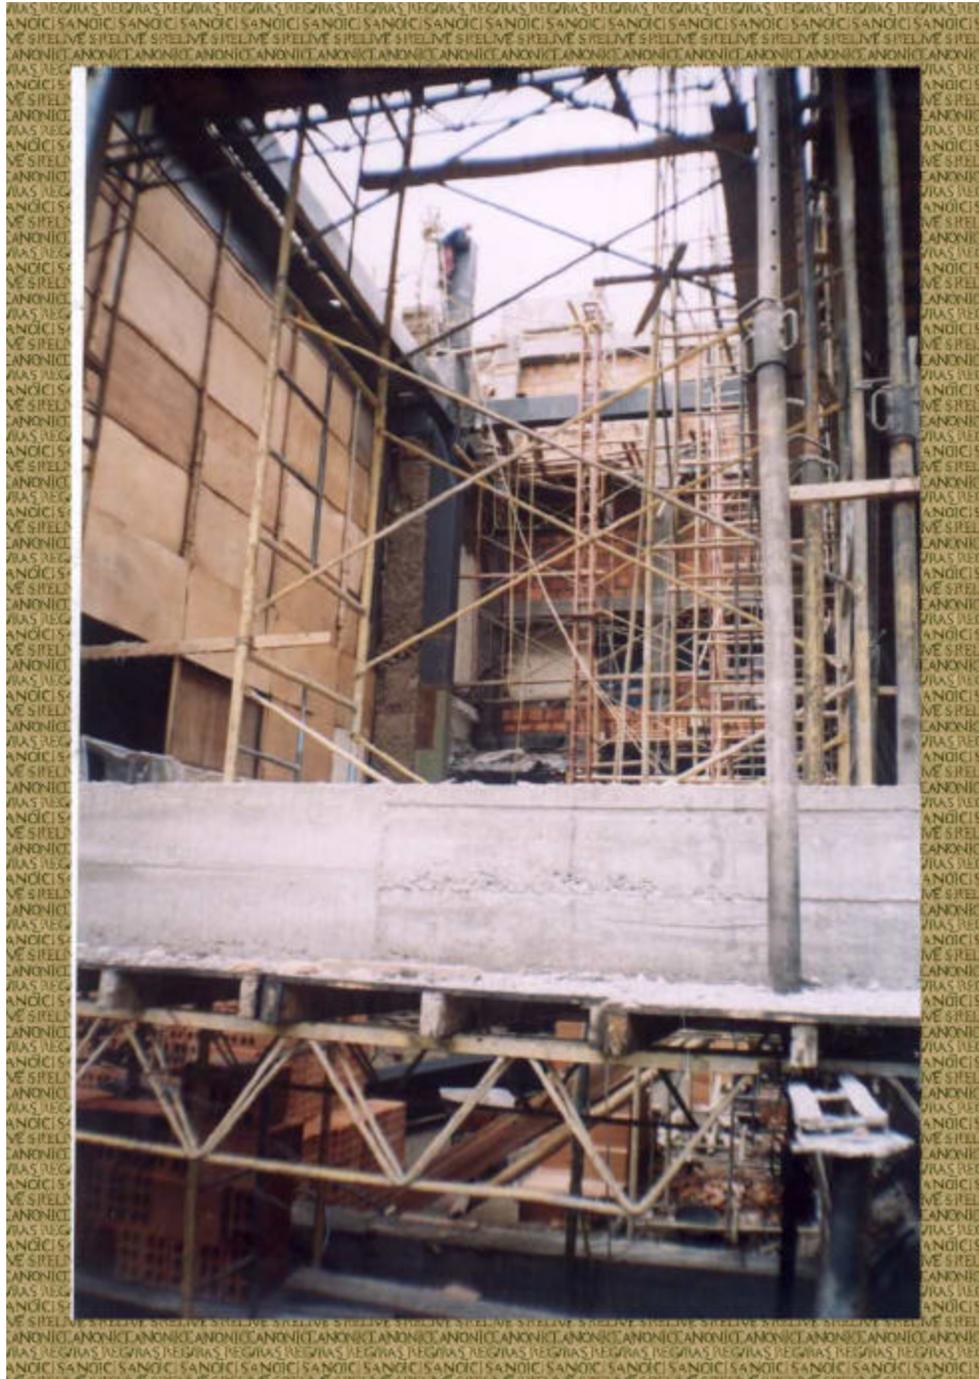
Montaje en la parte anterior del espesor de la tapia de una columna, la cual es soldada
